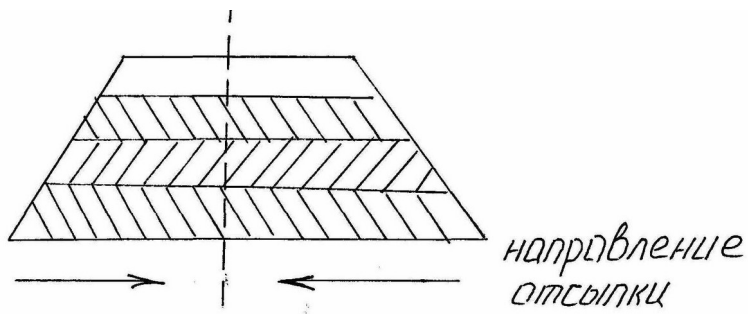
Схема отсыпки насыпи горизонтальными слоями
